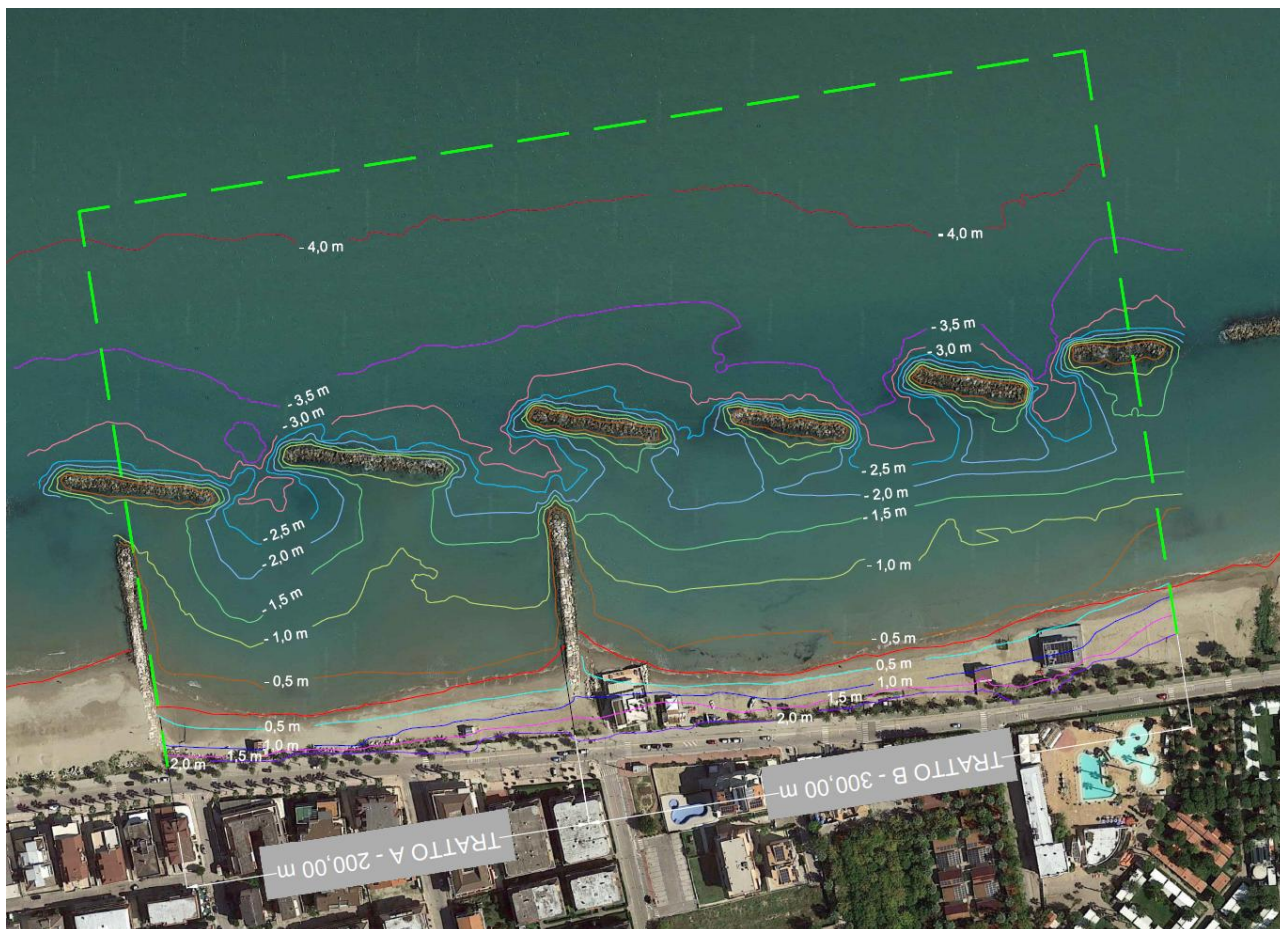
Estratto TAV. 10-b.1 Planimetria stato di fatto Martinsicuro Centro
